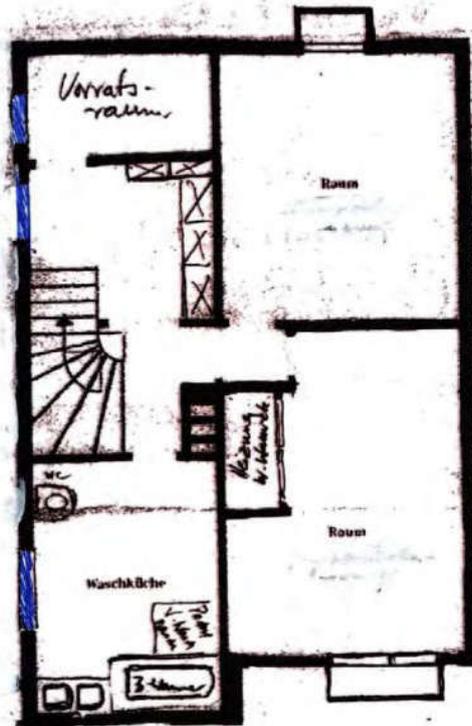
Grundriss OG (kein Originalgrundriss für das Bewertungsobjekt, ggf. mit Abweichungen, Vermaßungen wurden nicht geprüft)
